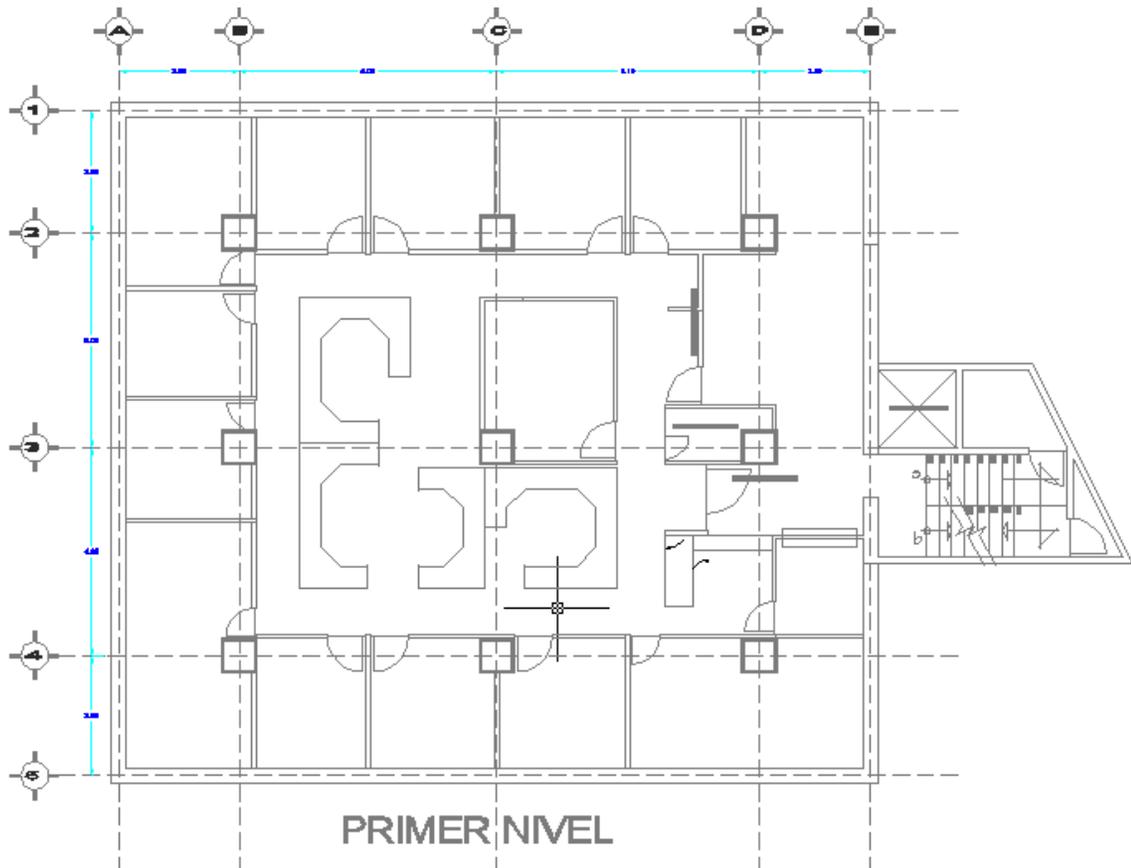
Vista de planta del plano arquitectónico del primer nivel.
